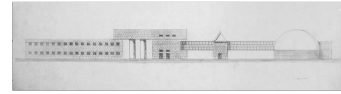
Ayuntamiento de Scandicci (Proyecto) Alzado 1968. Aldo Rossi.
